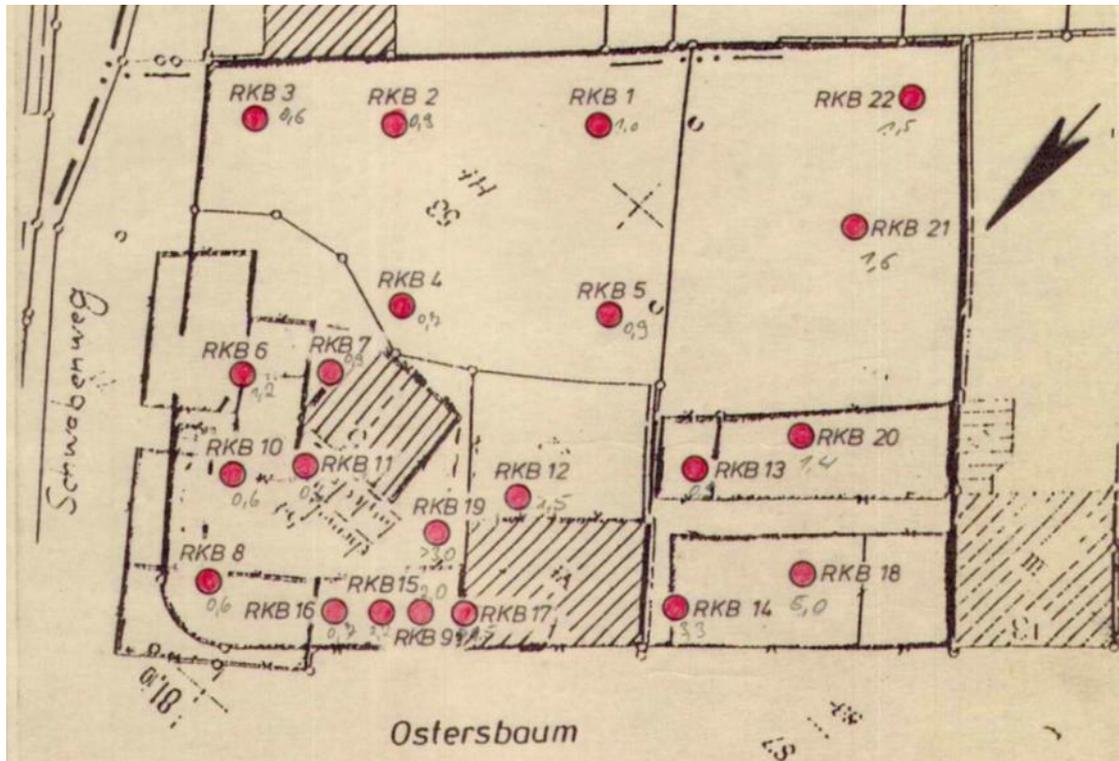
Auszug aus dem Lageplan zur Untersuchung der Gefährdungsabschätzung¹⁴ - Lage sämtlicher Rammkernsondierungen (rot)
